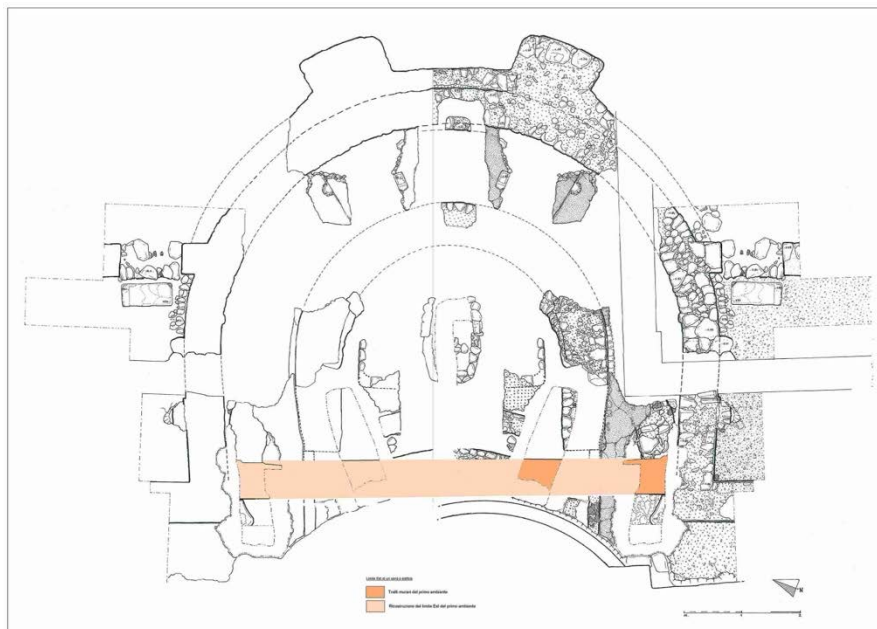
Il primo edificio, attestato dalla presunta parete orientale.
